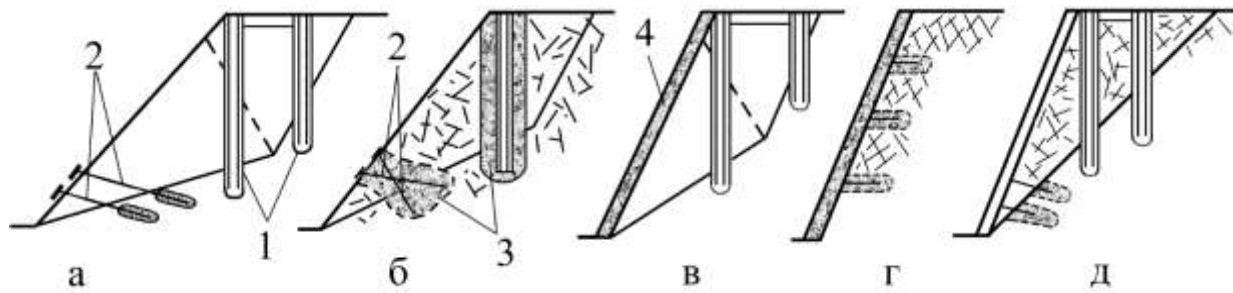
Схемы комбинированного укрепления откосов: *а* – железобетонные сваи со штангами или тросовыми тяжами; *б* – железобетонные сваи и штанги с цементацией или смолизацией; *в* – железобетонные сваи и *г* – штанги с изолирующим покрытием; *д* – железобетонные сваи со штангами и изолирующим покрытием; *1* – железобетонная свая; *2* – штанги (анкеры); *3* – зона цементации или смолизации; *4* – подвесная железобетонная стенка (изолирующее покрытие)
